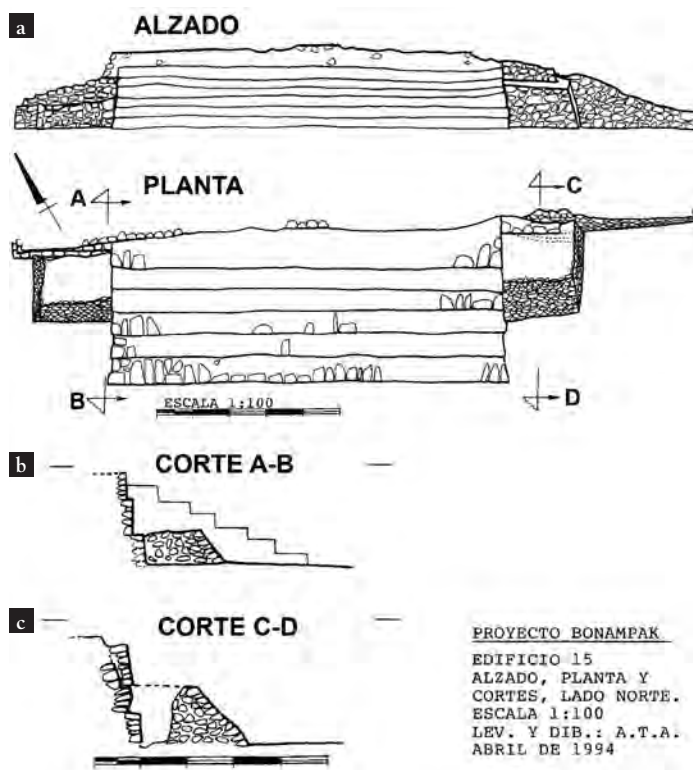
a) Alzado, b) planta y, c) cortes del lado norte.
